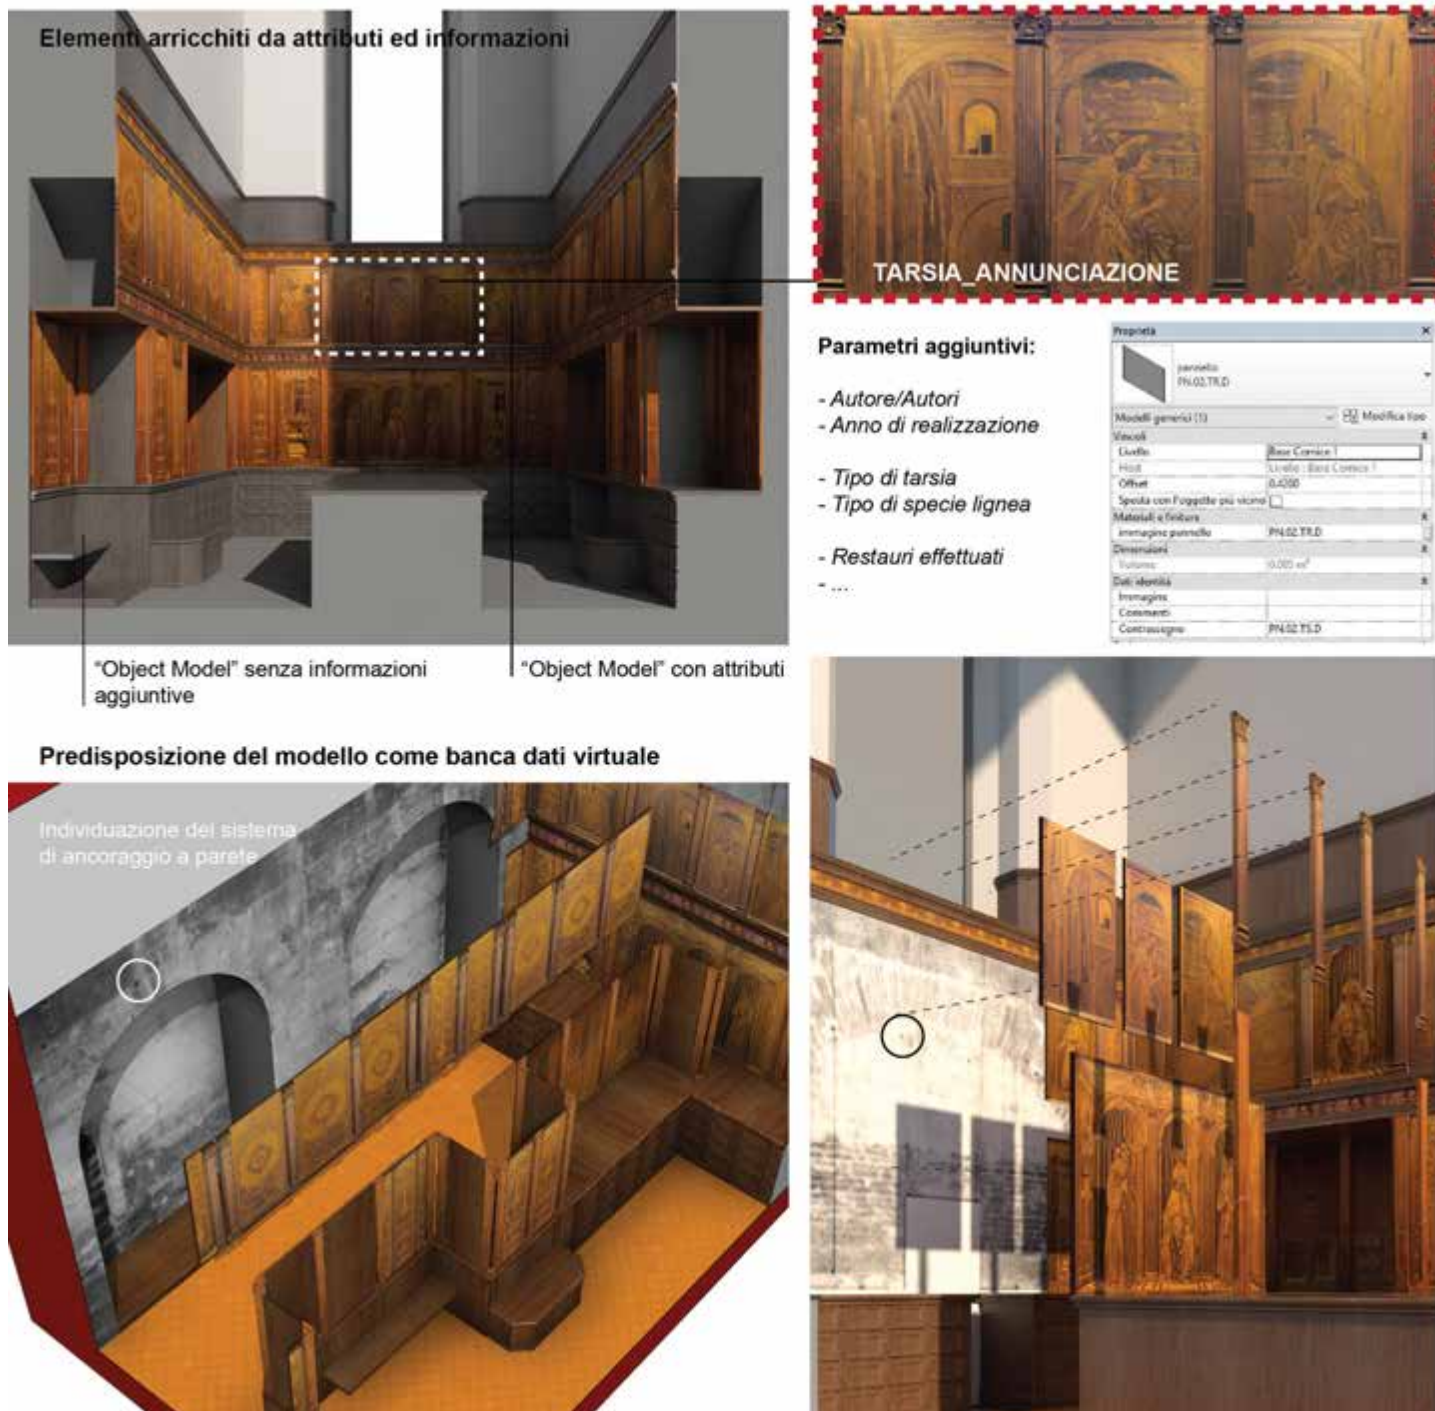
Arricchimento semantico del modello BIM: individuazione delle tessiture murarie, individuazione dei perni d'aggancio, modalità di montaggio dei pannelli e degrado delle murature.
